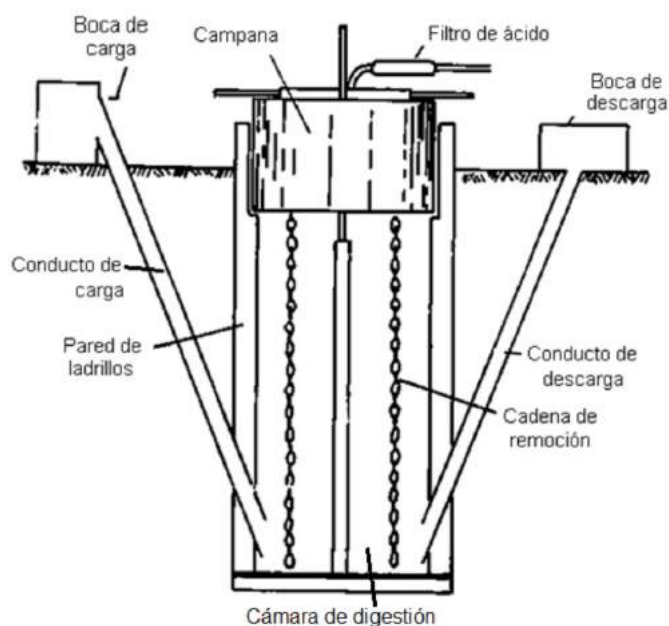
Digestor tipo Hindú. Sistema de remoción con cadenas. Fuente: Planta piloto de biogás, INTA Castelar
